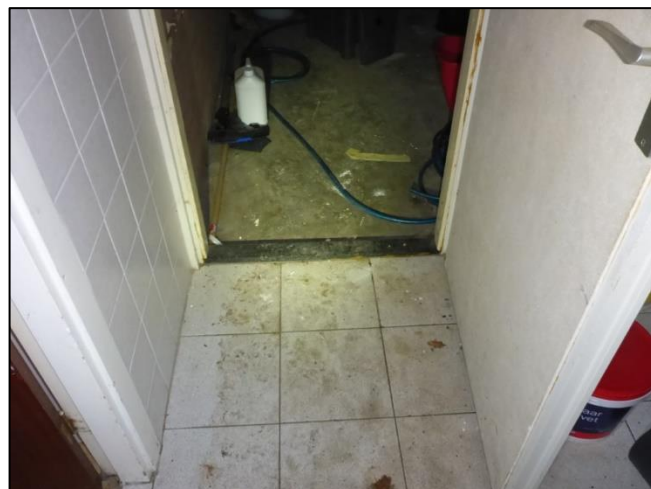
Berging: Vloerafwerking en dorpels (Niet asbestverdacht)
